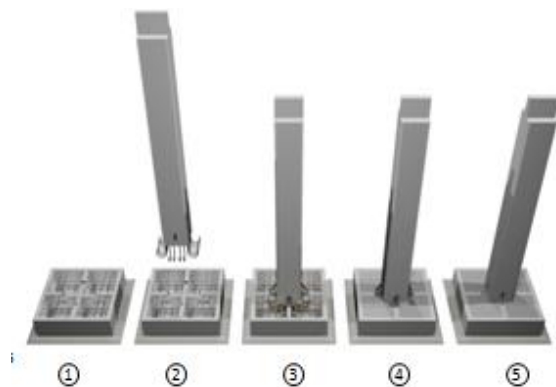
le montage du poteau préfabriqué et fondation préfabriquée
